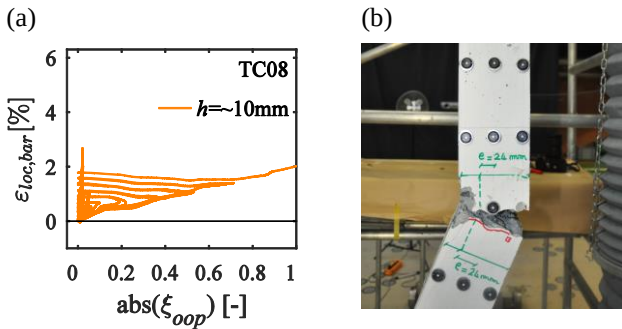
(a) Evoluzione della deformazione locale in corrispondenza dell'armatura; (b) Dettaglio dell'unità di prova TC08 dopo la rottura.
